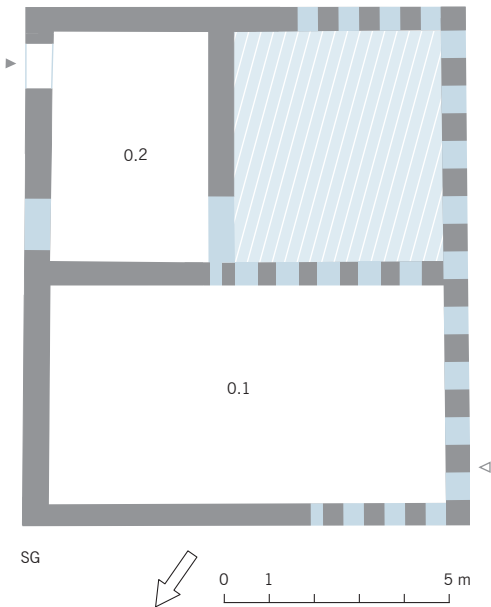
Neudorfstrasse 6 in Menzingen, Grundriss des Sockelgeschosses.
